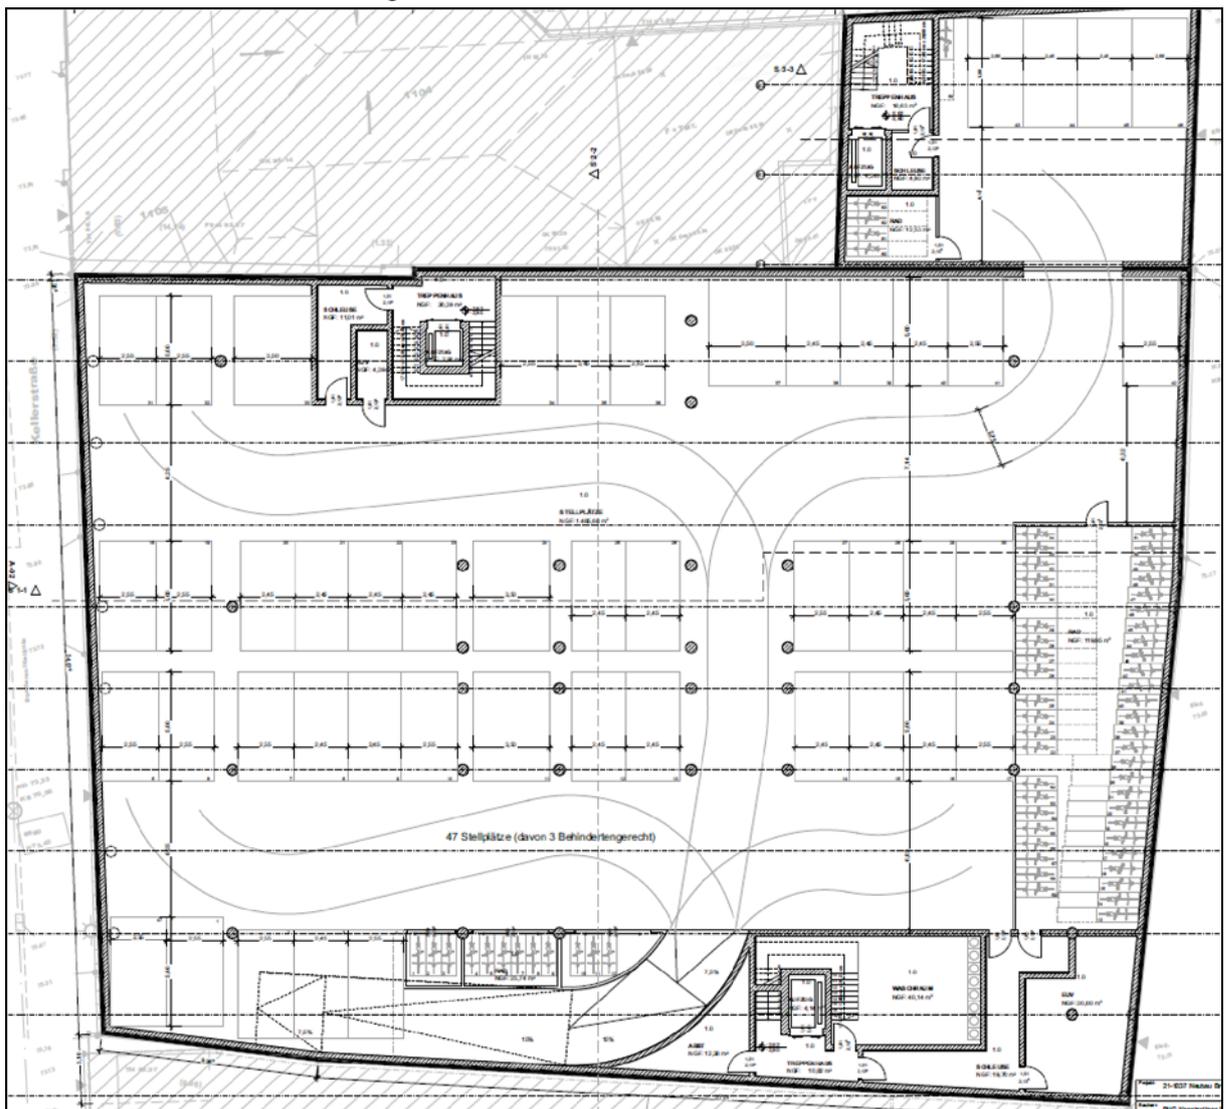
Tiefgaragengeschoss Pkw und Fahrräder (Steinke + Zils Architekten)
